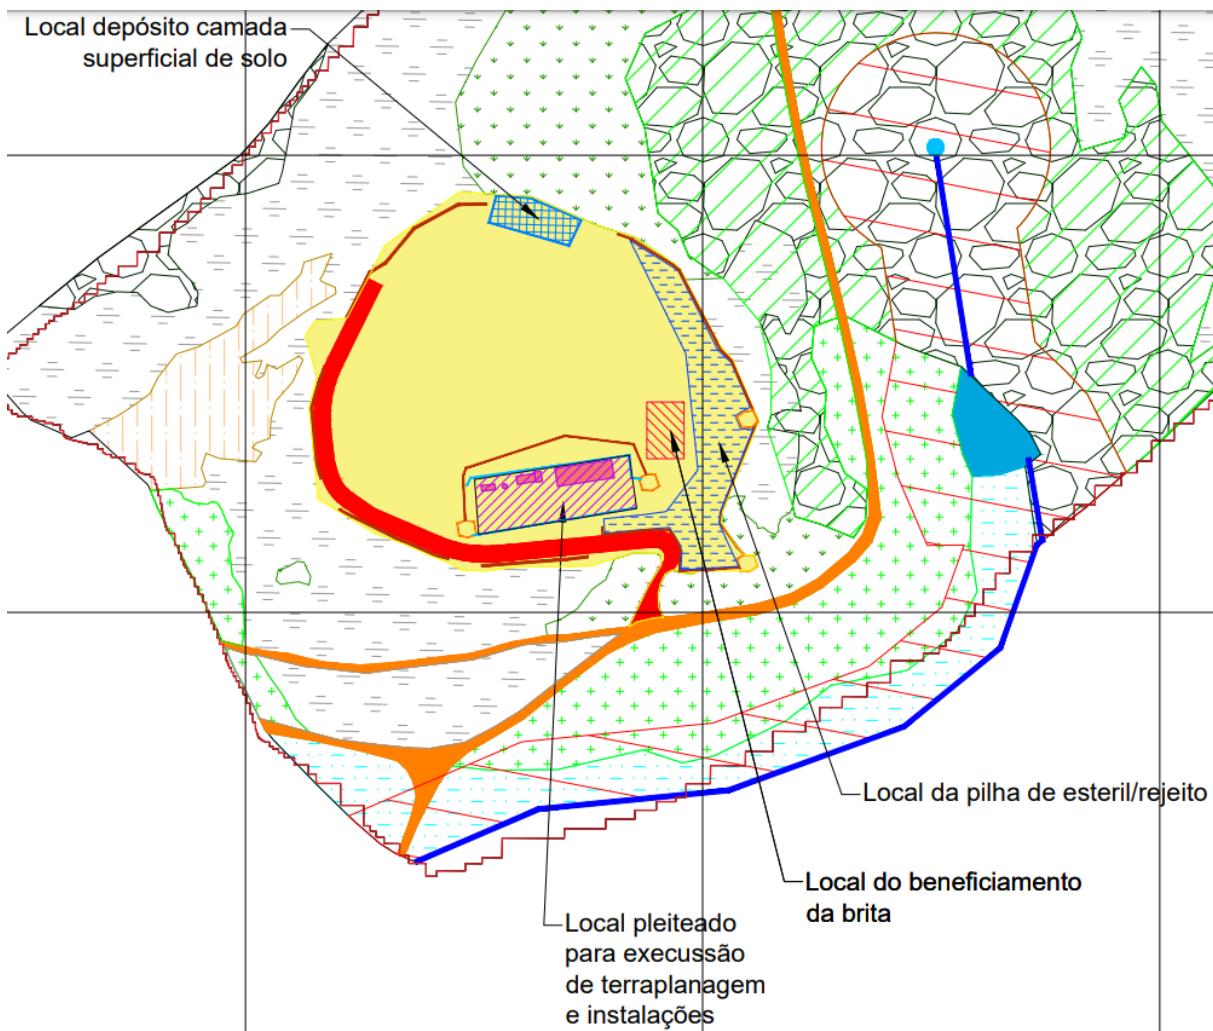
Estruturas do empreendimento. Fonte: SLA.
